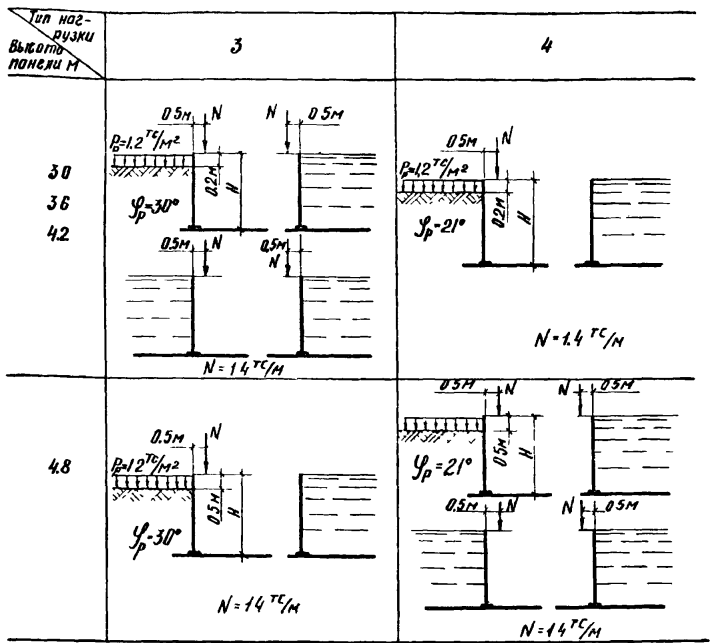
Схемы расчетных нагрузок на консольные стены высотой 3,0 + 4,8 м.
